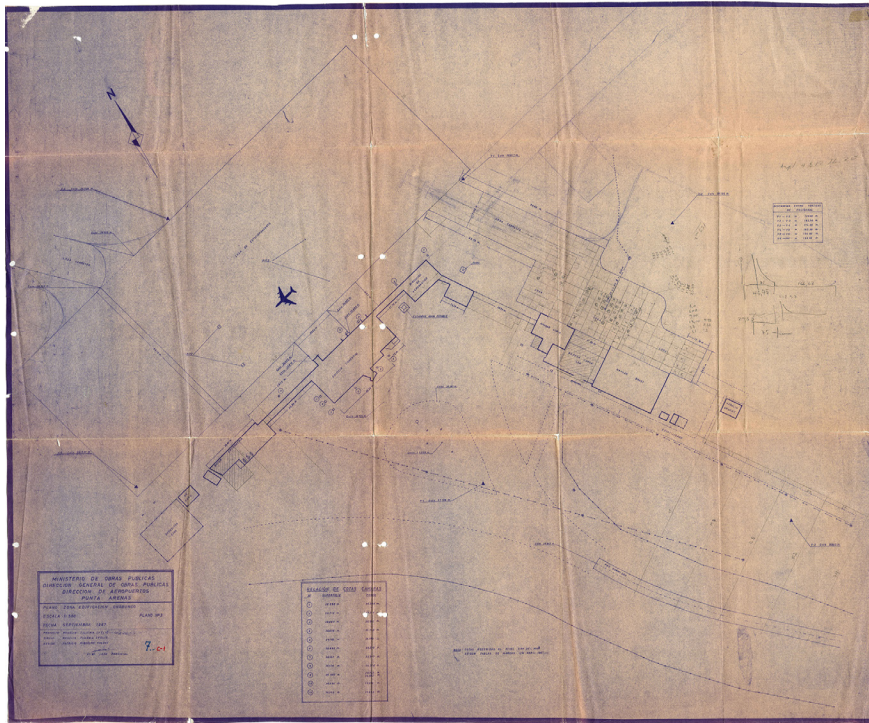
Zona edificación de Chabunco (fuente: Ministerio de Obras Públicas, 1967a).
